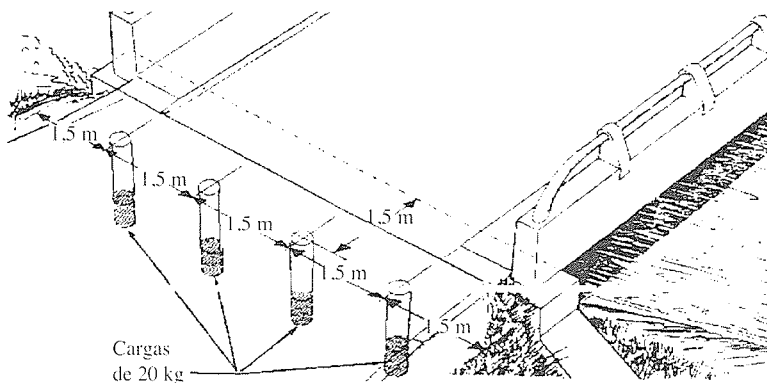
Destrucción de estribos de espesor menor que 1,5 m
